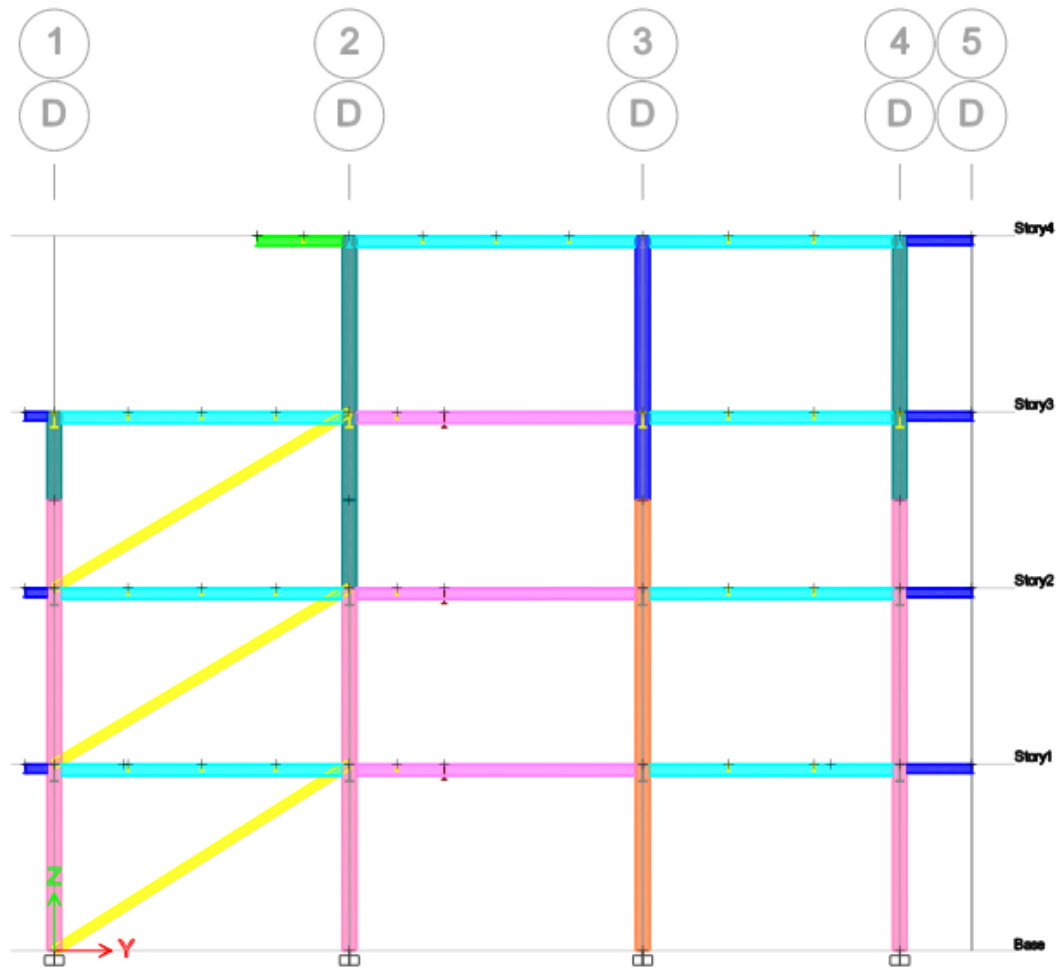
Diseño de reforzamiento estructural para la edificación seleccionada Eje-D.
